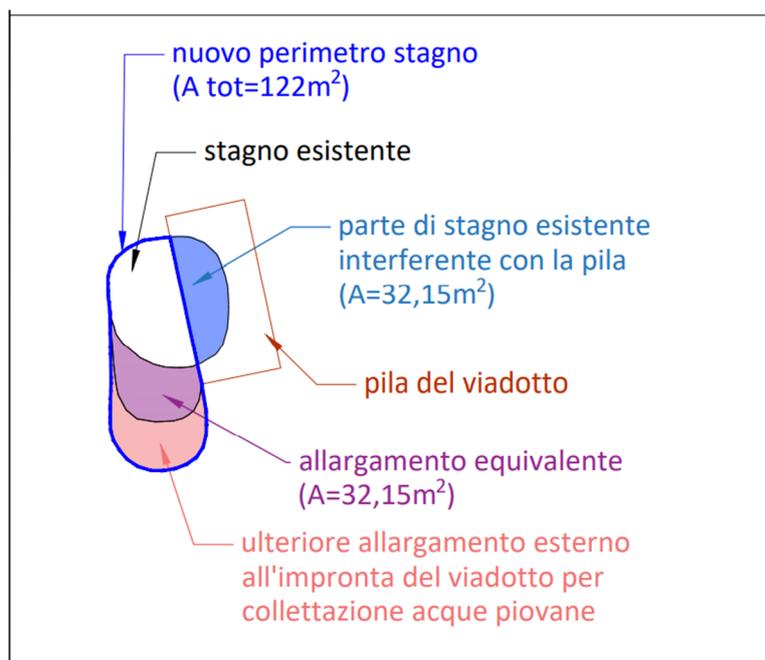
Schema del progetto di allargamento conservazionistico dello stagno
